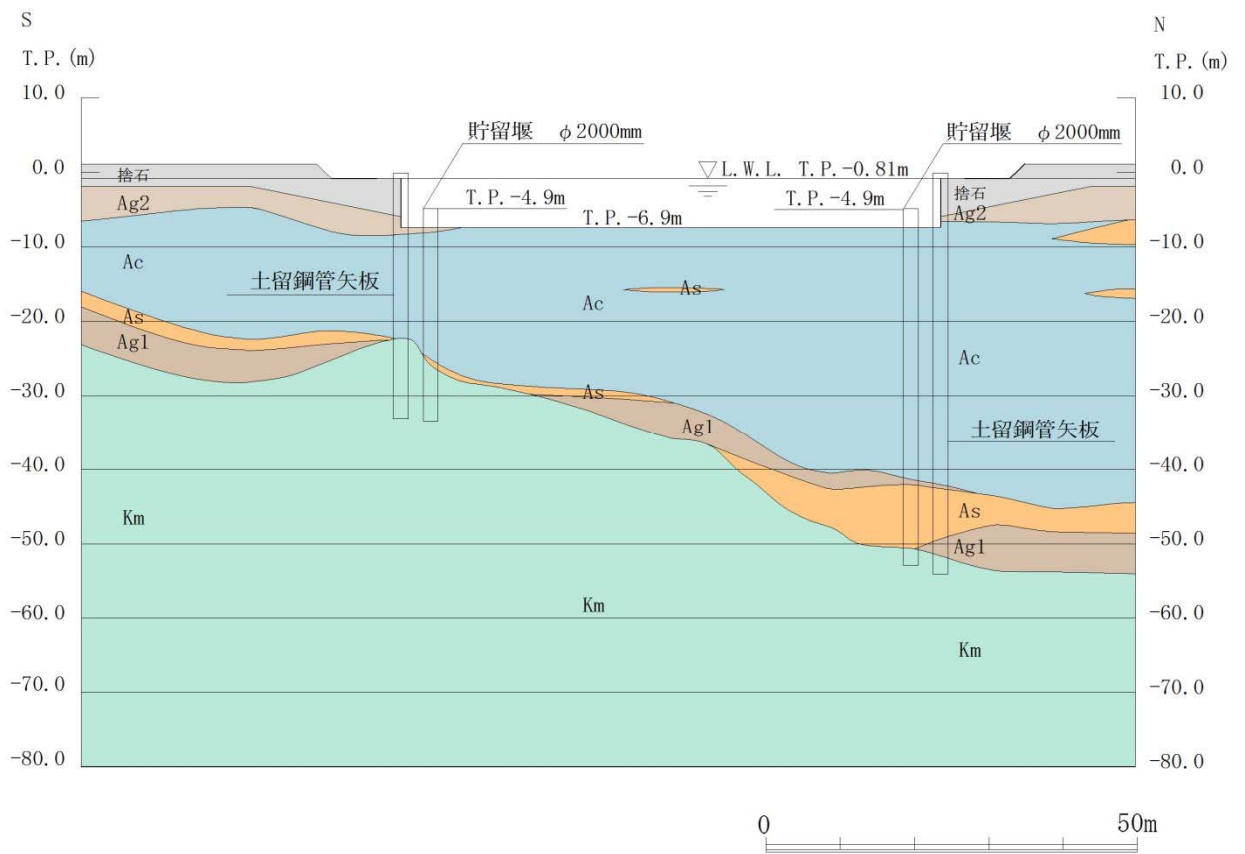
土留鋼管矢板の断面図 (NS-1)
